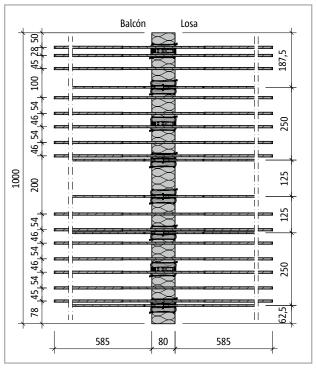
Schöck Isokorb® T tipo K-M4-V1: Plano del producto
